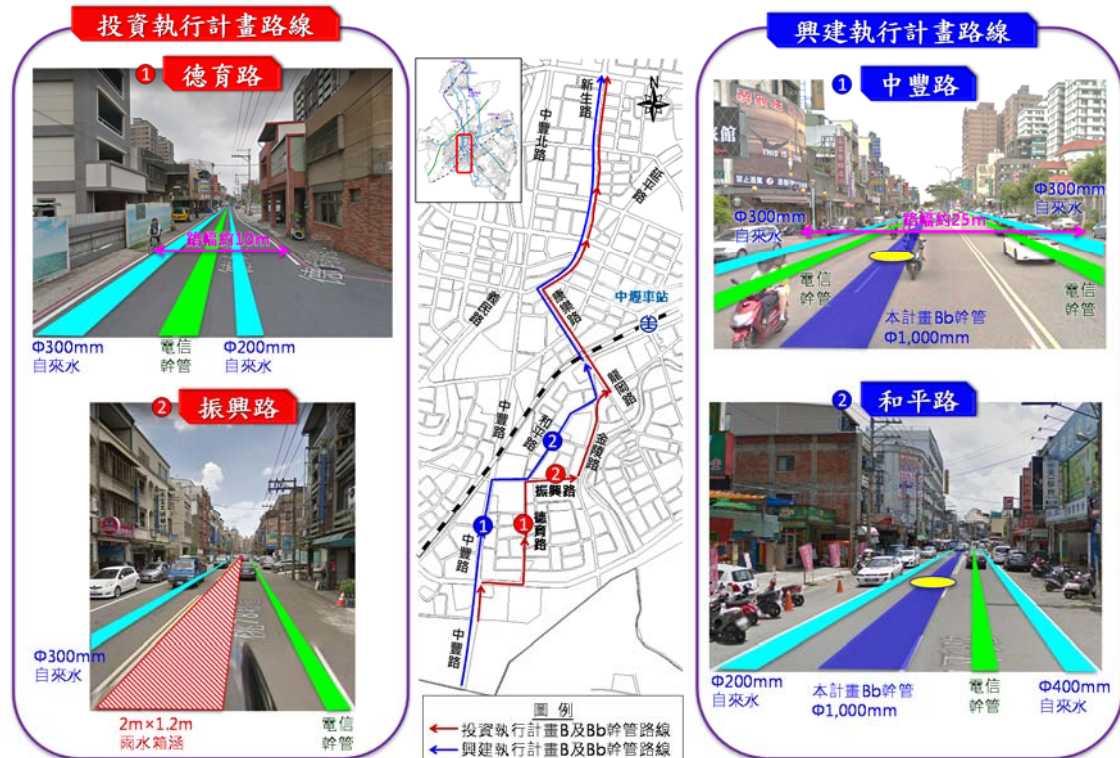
Bb、B 及 A 幹管剖面圖
